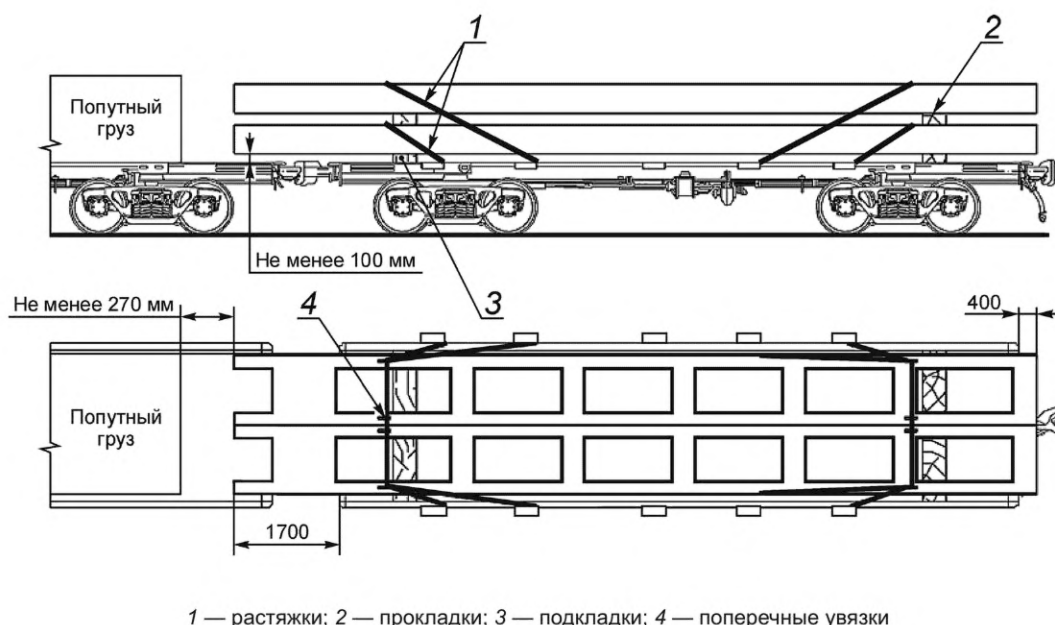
Схема перевозки двухветвевых колонн на платформах
